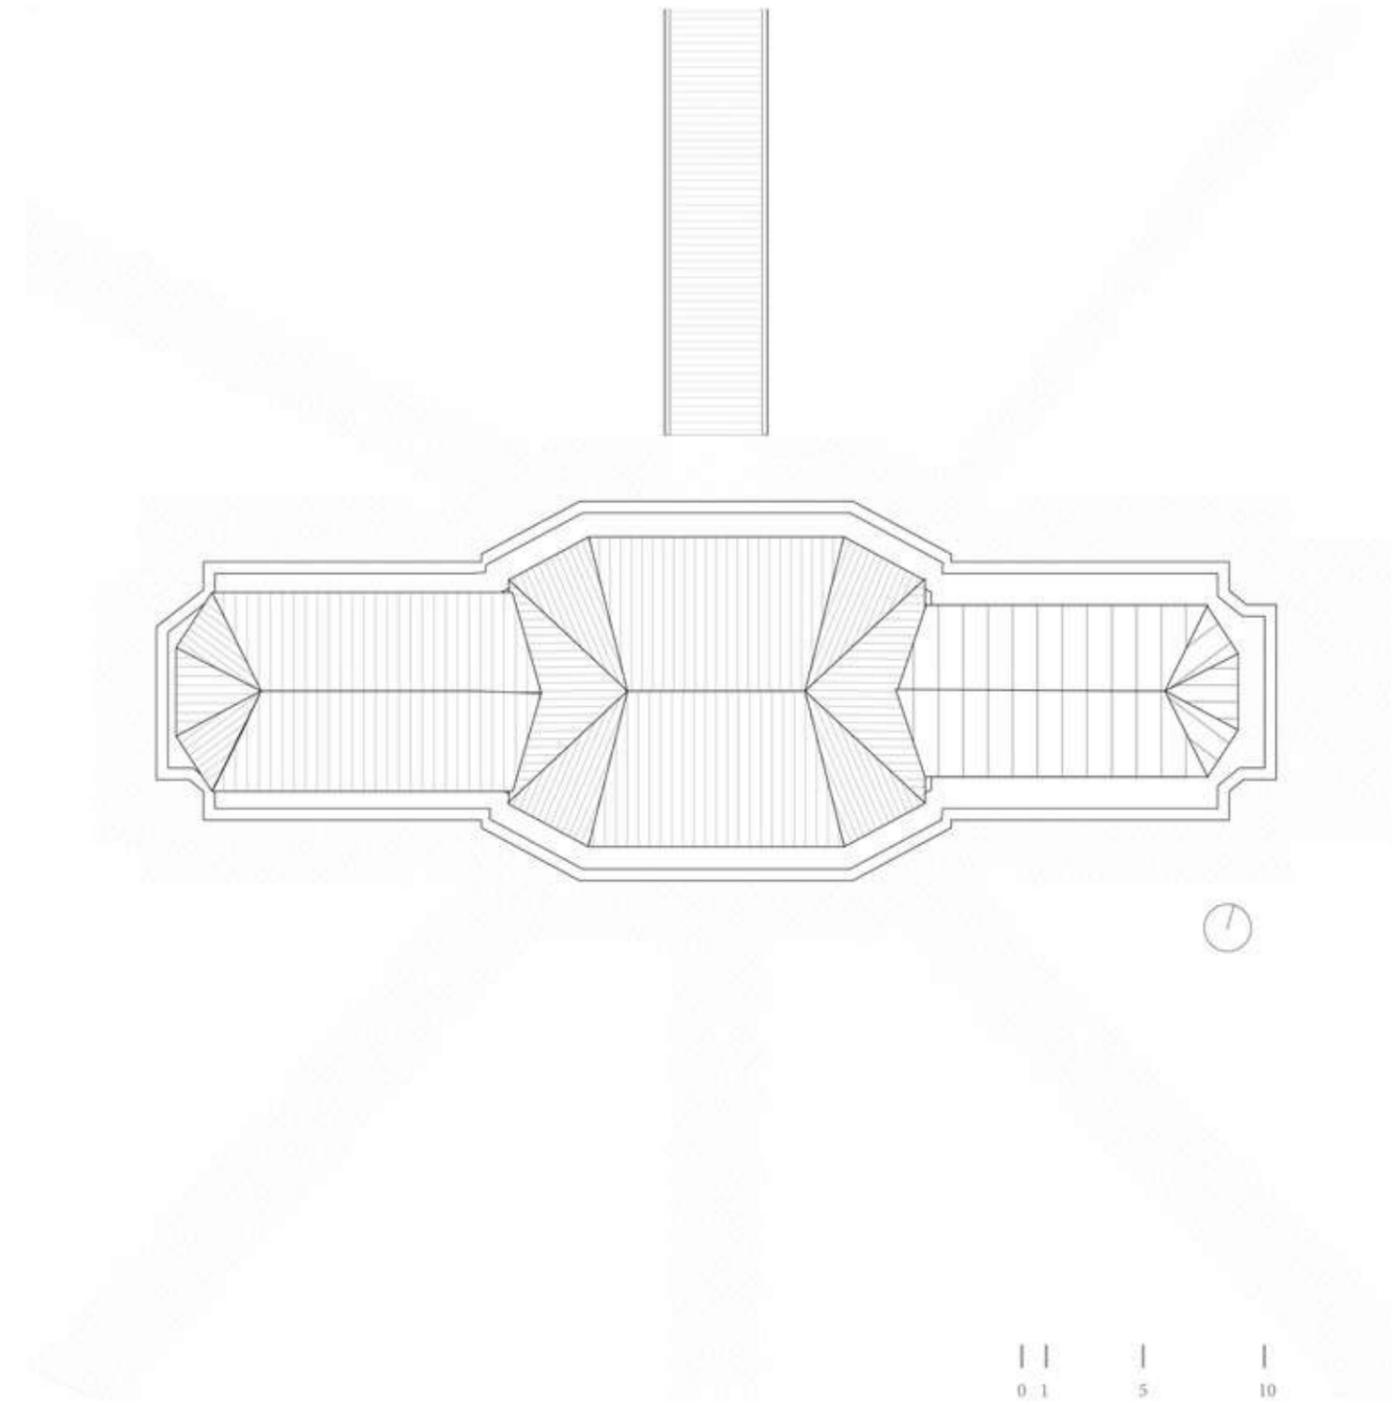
Dachdraufsicht Jagdschloss, M 1:200
